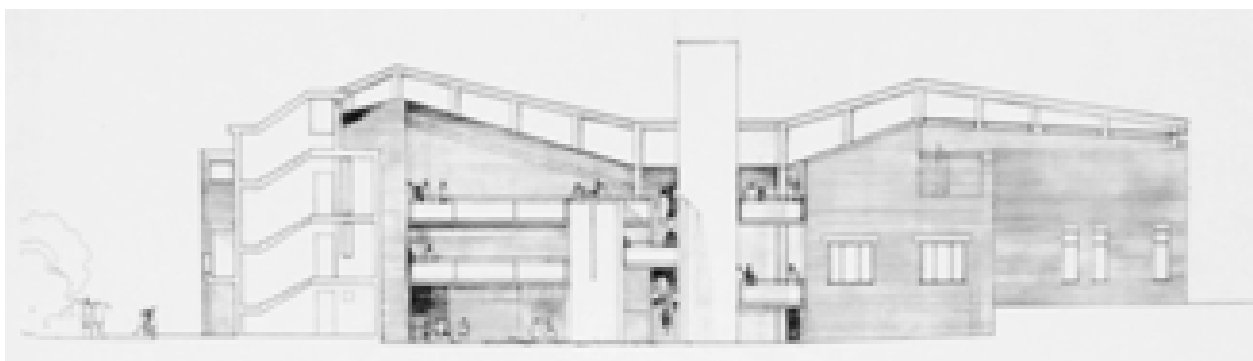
Prospetto Sud, stato futuro –10/09/2007 (AABS-1996.46)
